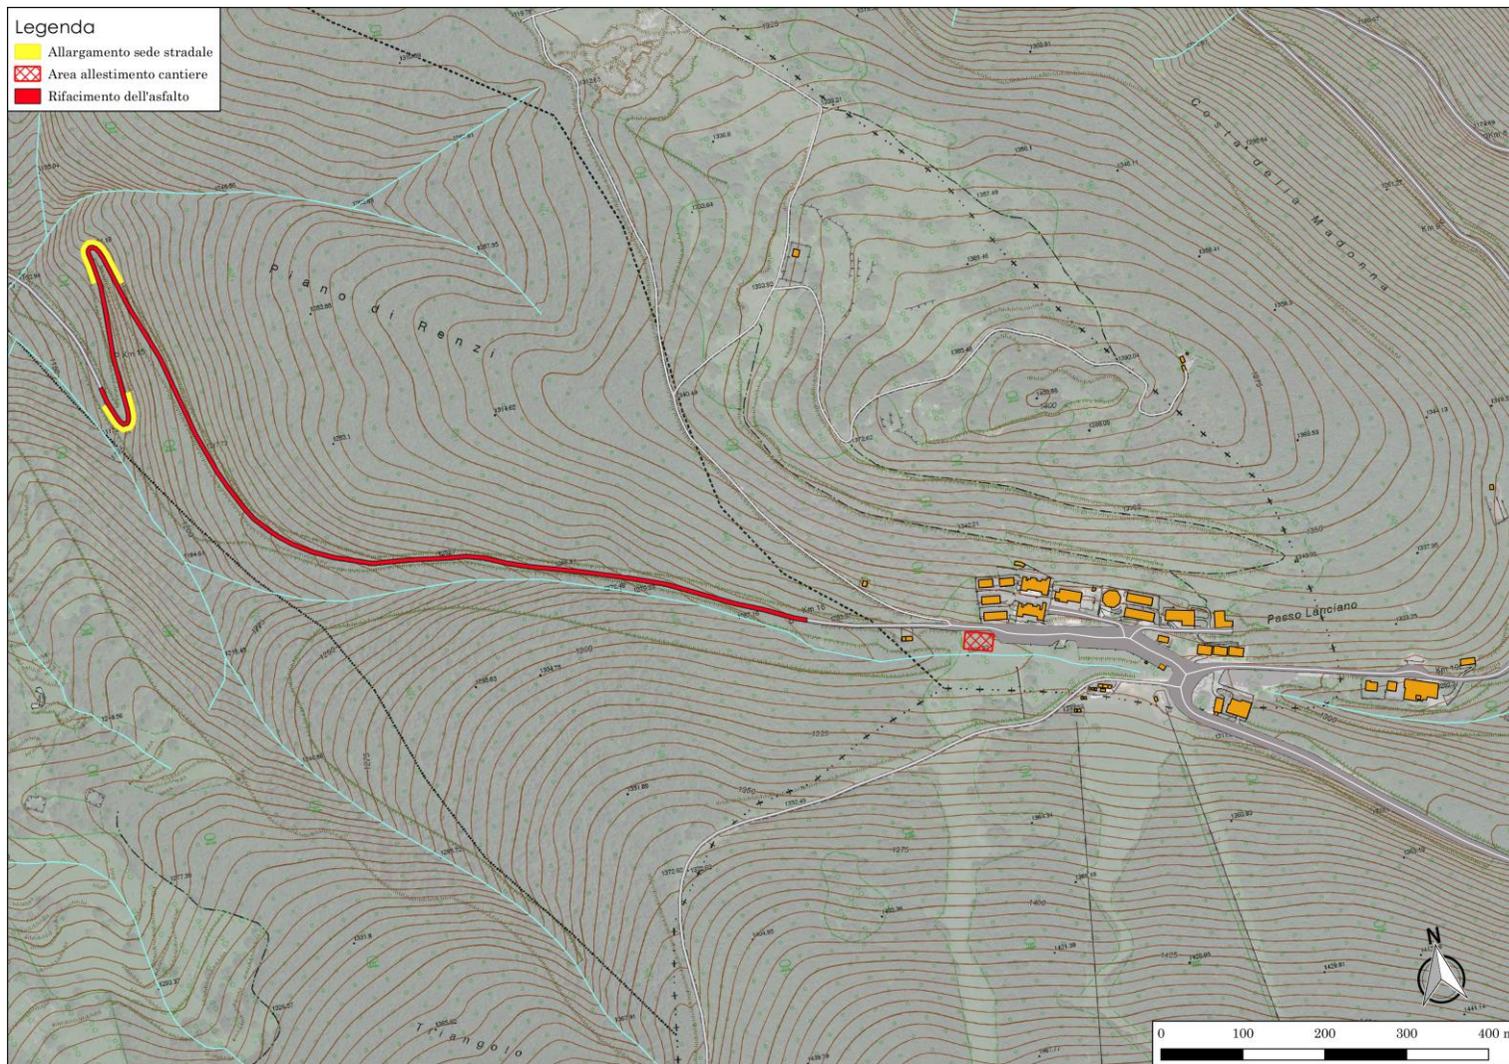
Planimetria ubicativa dell'area di cantiere per la realizzazione delle prime 5 fasi lavorative previste nella Tabella 1.
